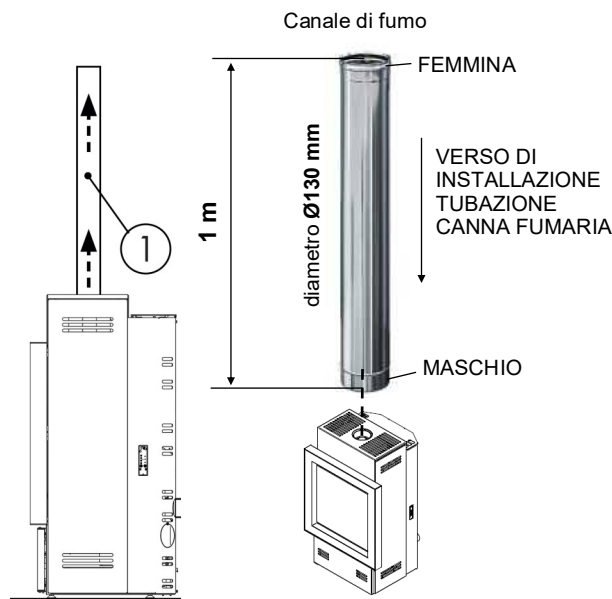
Installazione tratto rettilineo unico del canale di fumo.
